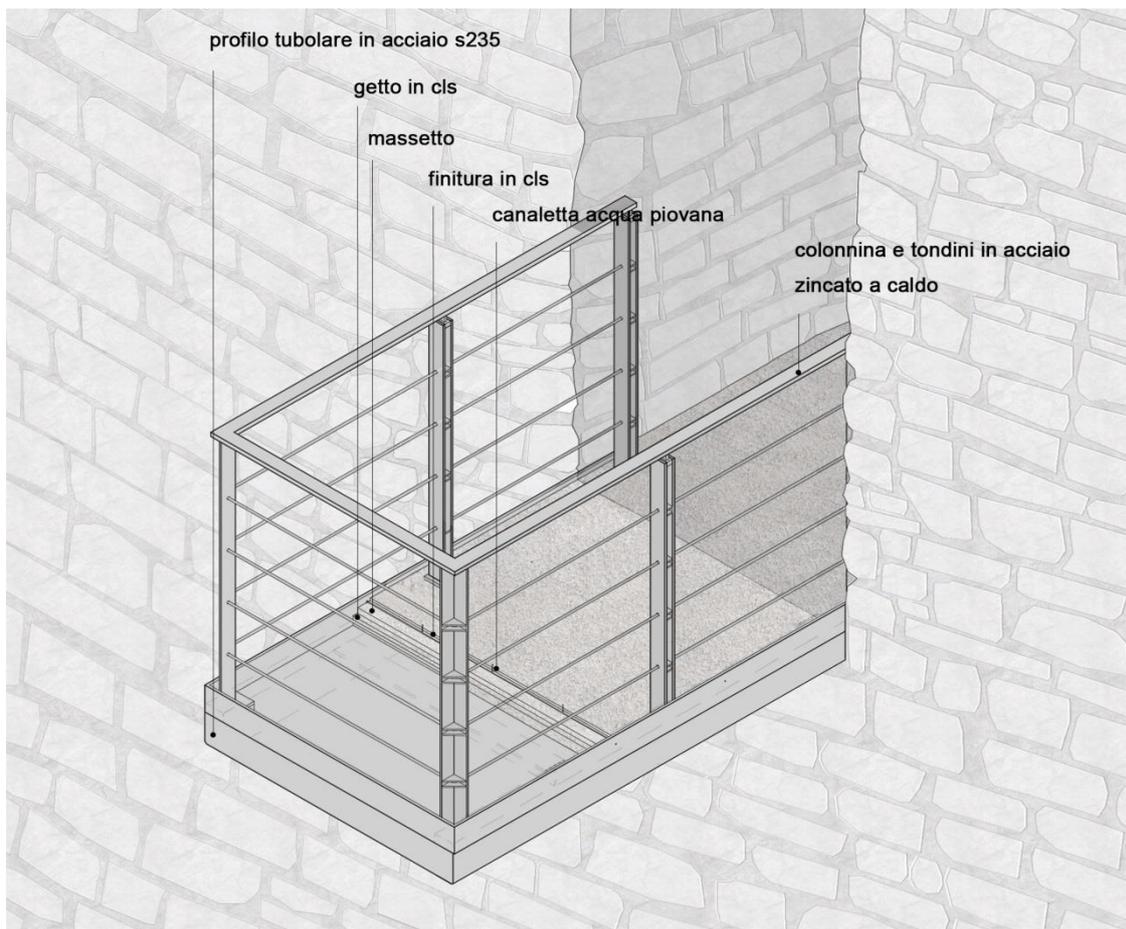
Dettaglio struttura a sbalzo in acciaio.
